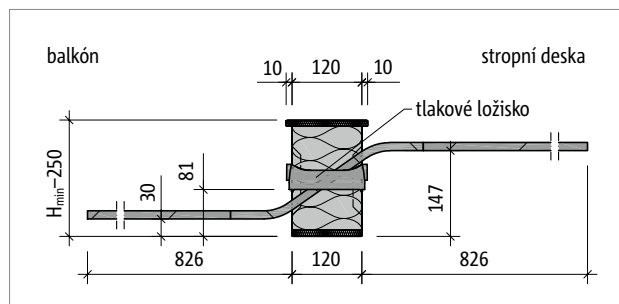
Schöck Isokorb® XT typ QL-V5: Řez prvkem
